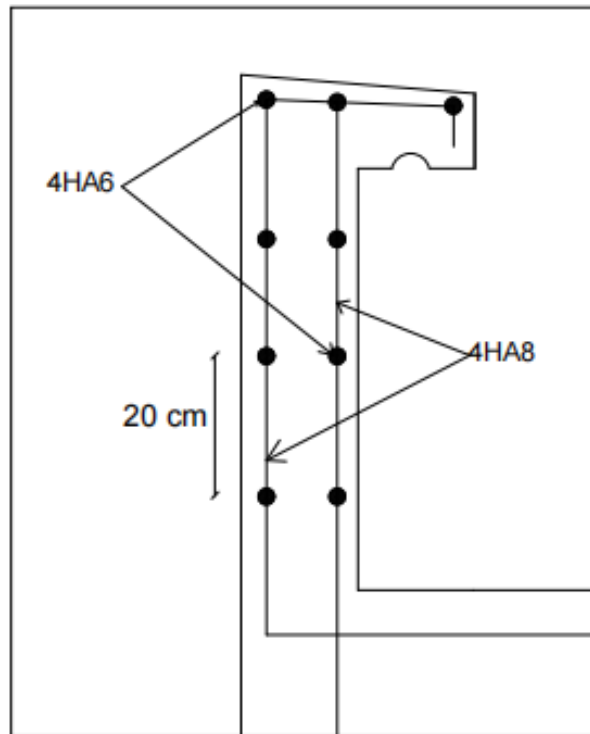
Schéma de ferrailage de l'acrotère coupe A-A.
